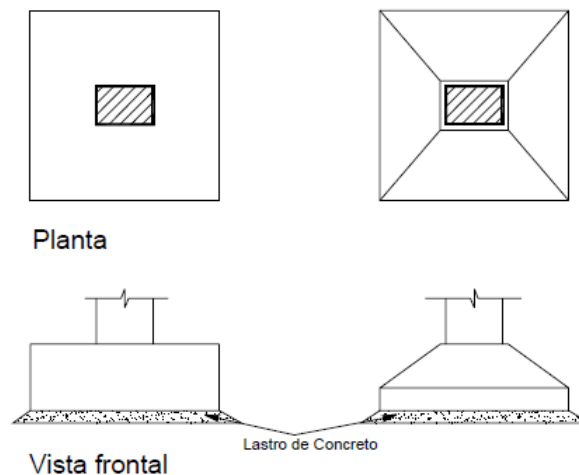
Sapata isolada (vistas) e lastro de concreto.
